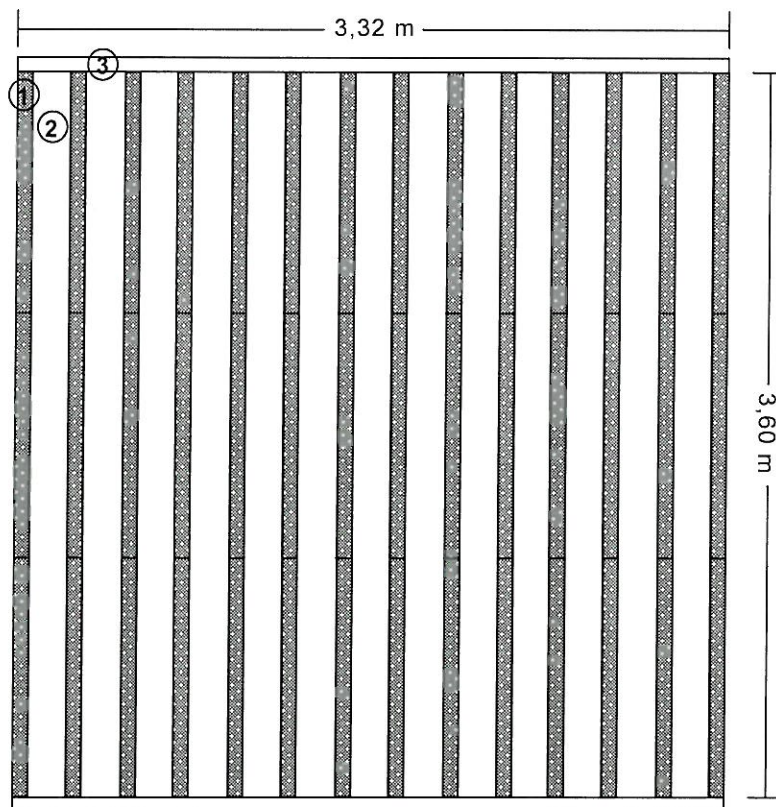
Detailzeichnungen (Schnitt durch einen Abstandshalter Schnitt durch den Prüfaufbau) sowie Ansicht des Prüfaufbaus im Hallraum; (Prüfobjekt S 10362-02; Maße in Millimeter (mm)).
